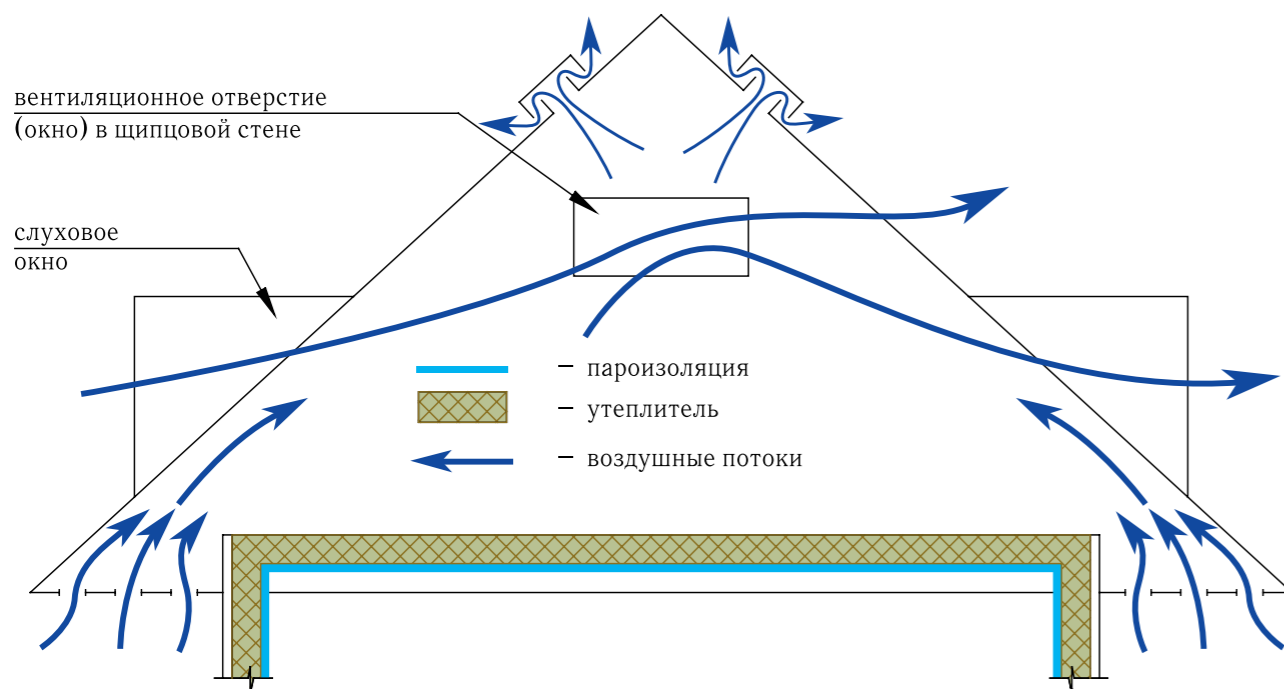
Схема утепления, пароизоляции и вентиляции нежилого чердачного помещения
